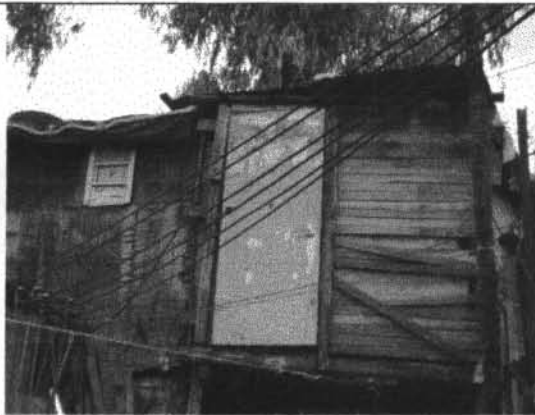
Estructuras de madera con instalaciones eléctricas con protección deficiente.
